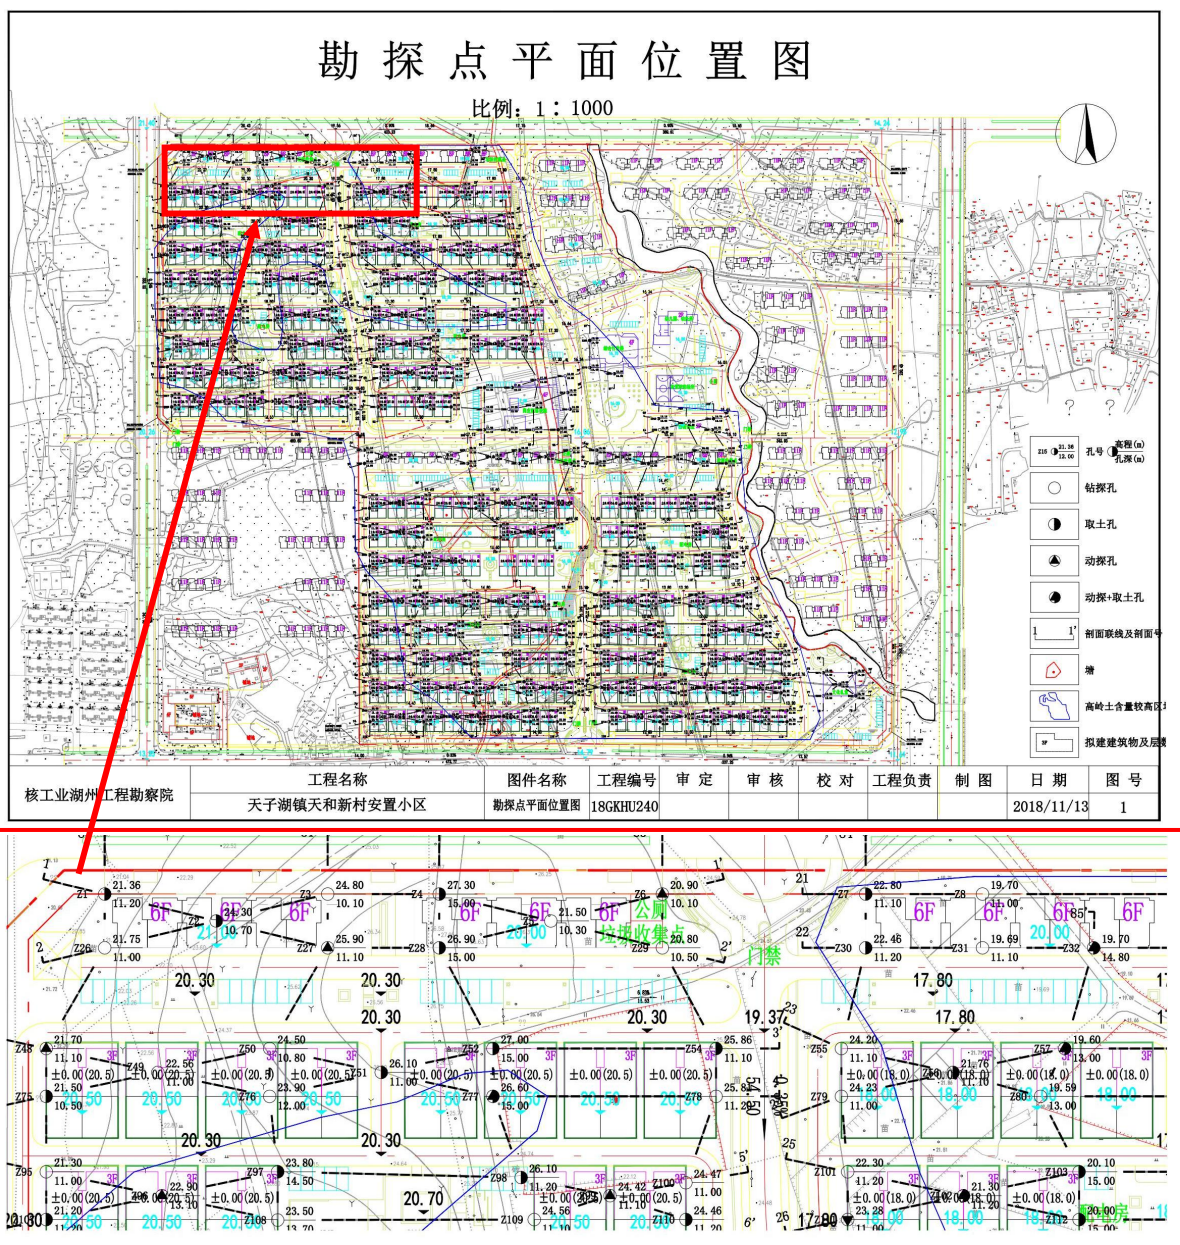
勘探点平面位置图 (标红框位置为引用工程地质剖面图所在位置)
